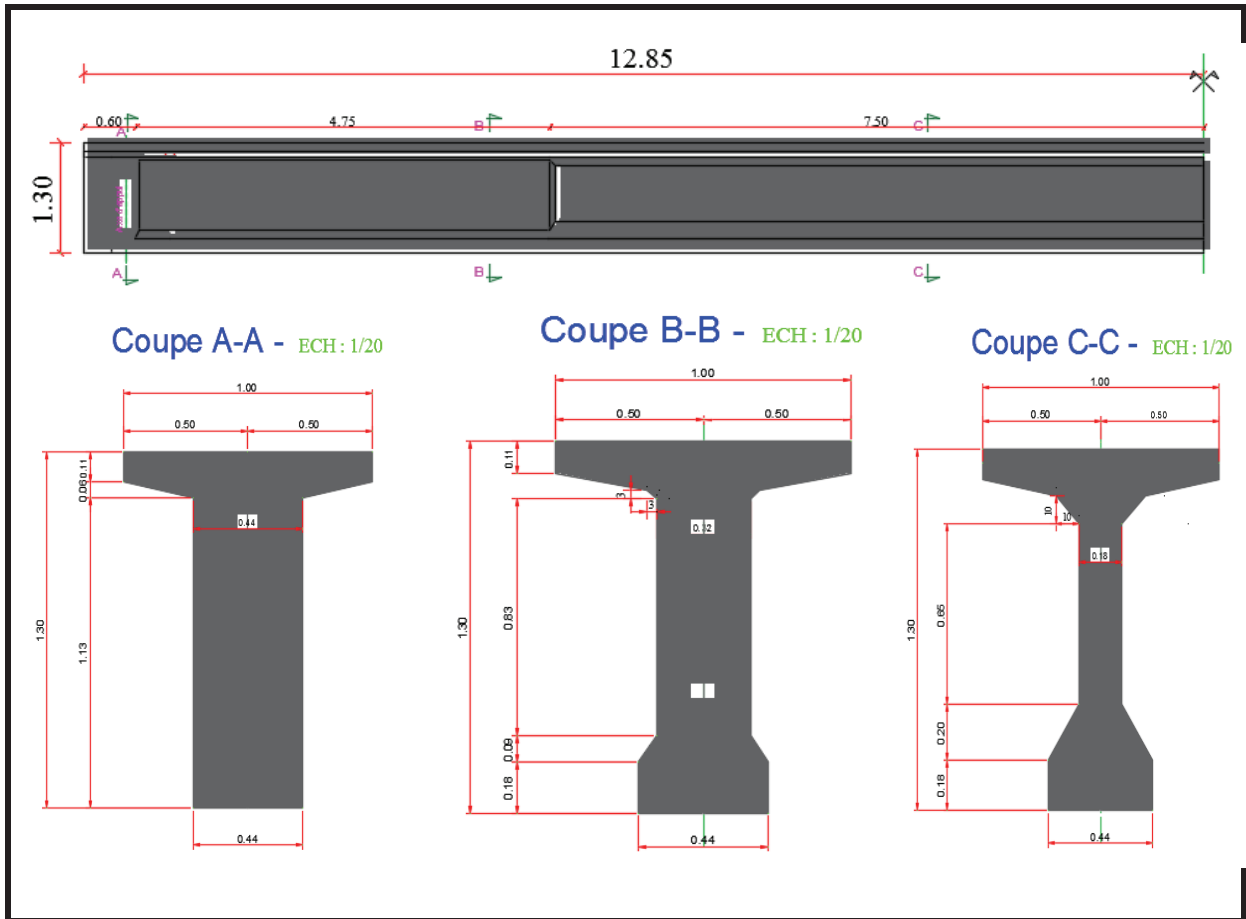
Différentes sections de la poutre de la variante VIPP.
